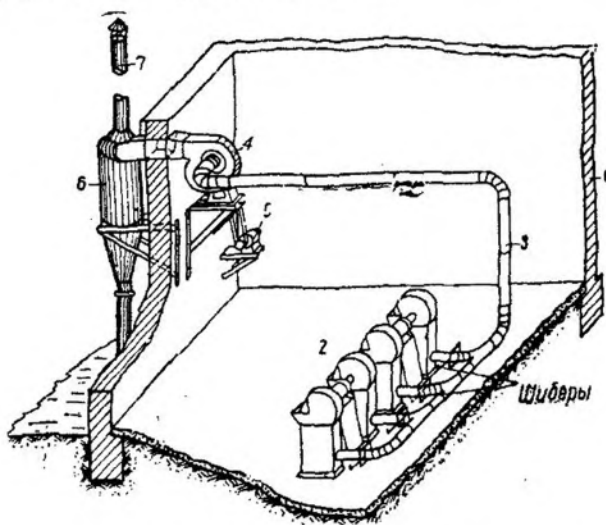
Схема вытяжной вентиляции с местными отсосами
